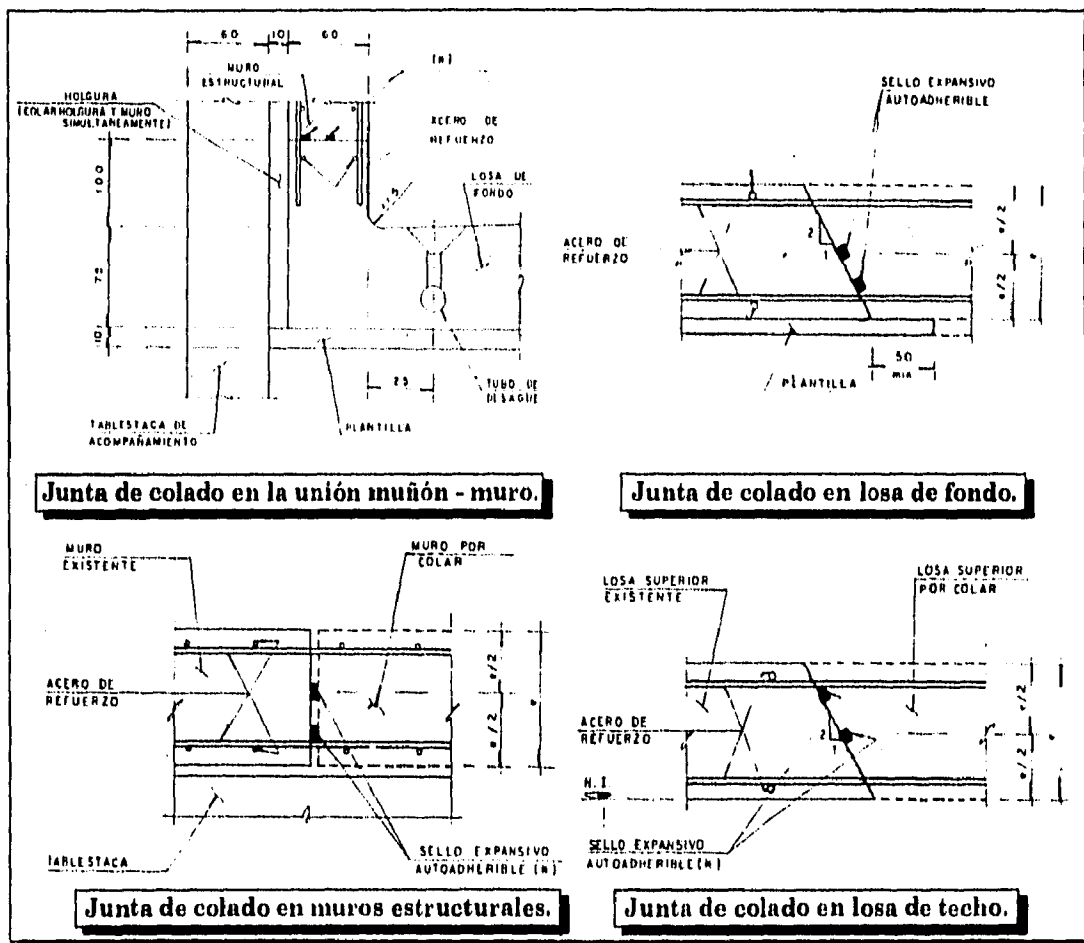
Detalles de juntas de colado y sellado de las mismas.
